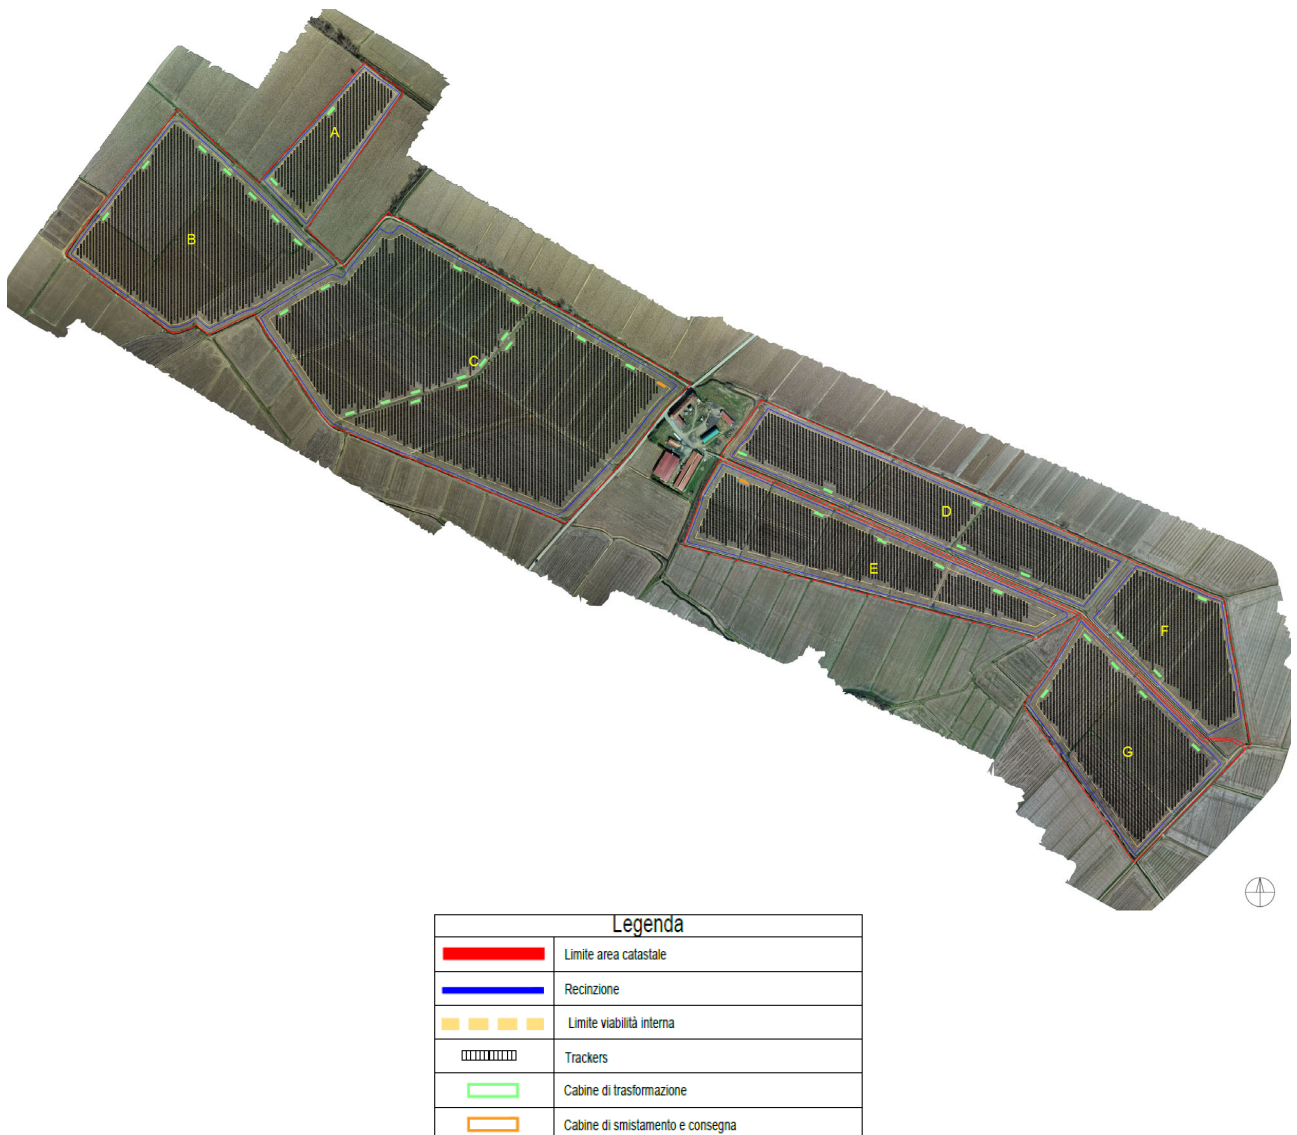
estratto layout di progetto con ubicazione impianti esterni
